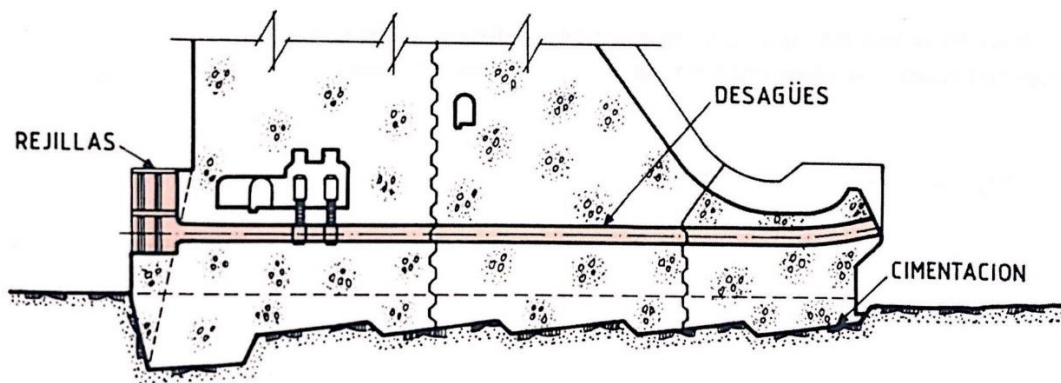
Sistema de descarga de fondo. [1⁹]
